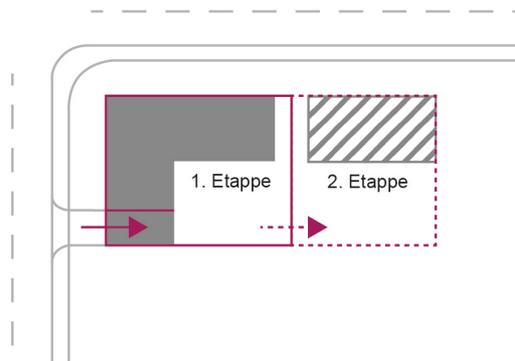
Anordnung von unterirdischen Sammelgaragen mit Erweiterungsoption. Das Rampenbauwerk ist in das Gebäude integriert.
